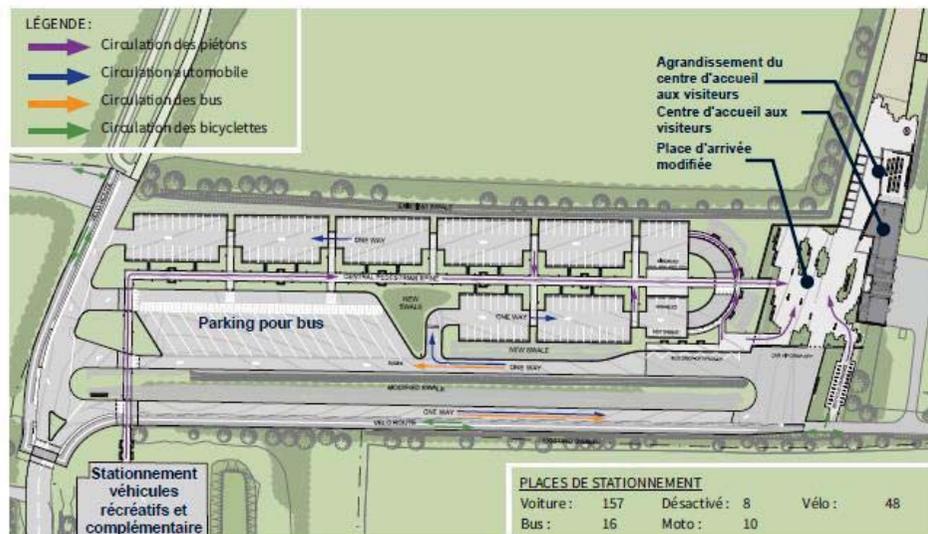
Disposition de l'aire de stationnement proposée - Source : Permis de construire
